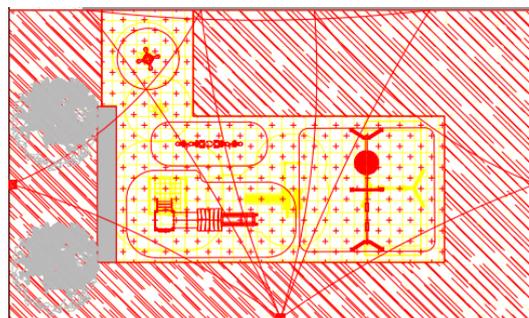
Planta de alterações | Fonte: autora, 2023 | sem escala
